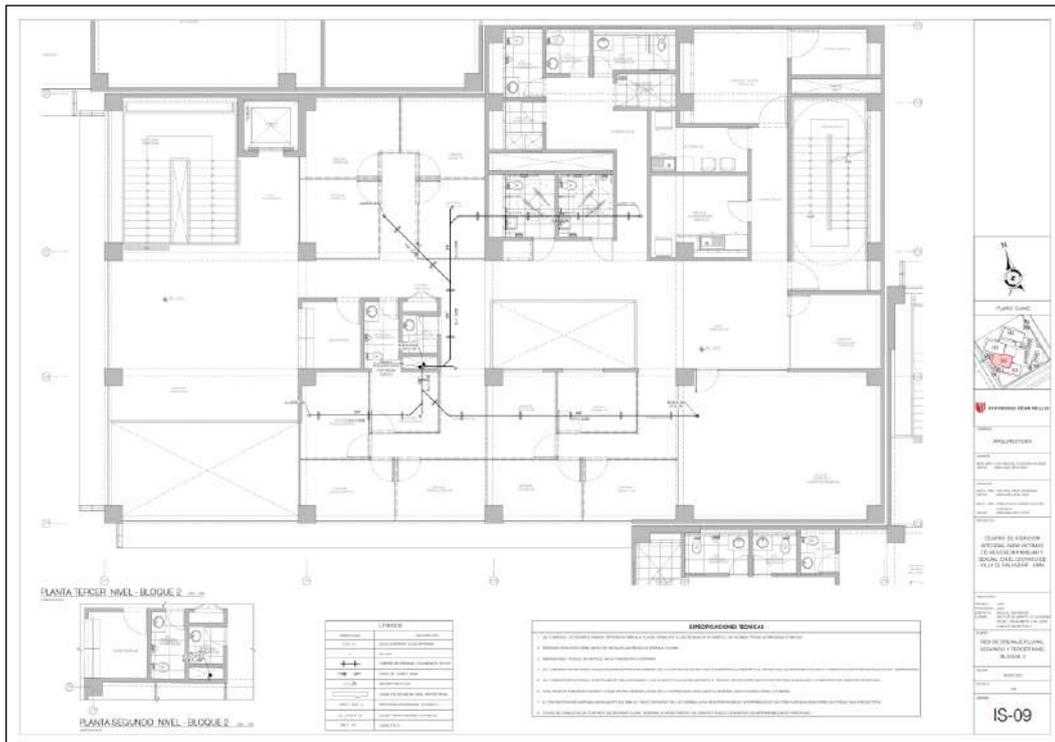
Planta segundo y tercer nivel red de drenaje pluvial – bloque 2.
